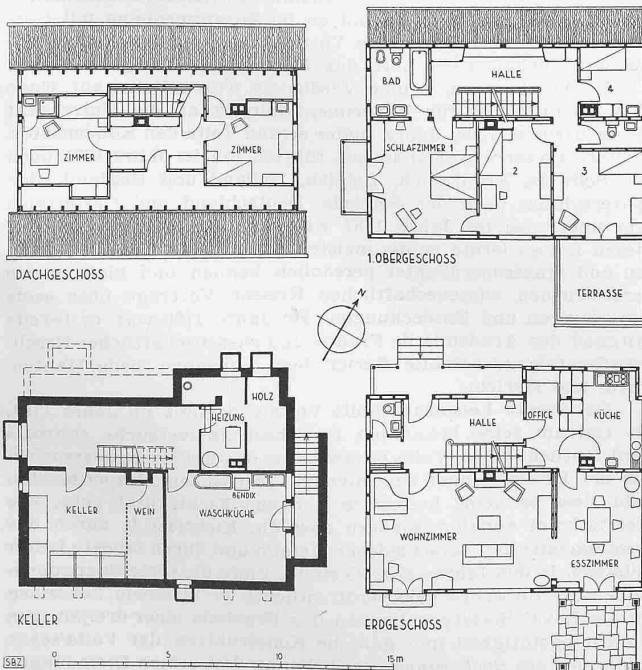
Grundrisse des Holzhauses in Zollikon. — 1:300
